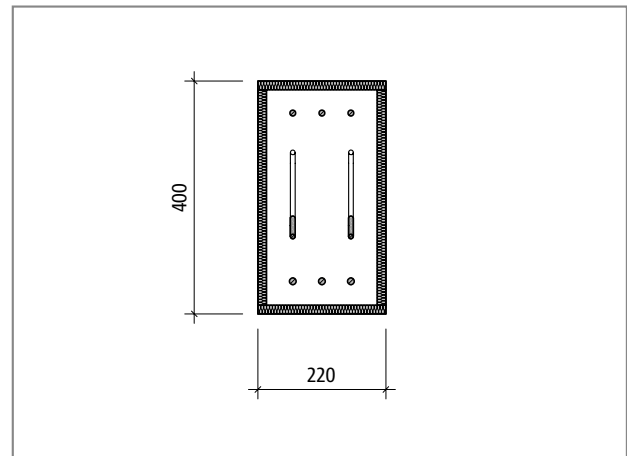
Schöck Isokorb® tipo SXT, R90: vista dell'elemento, rivestimento con pannelli antincendio
